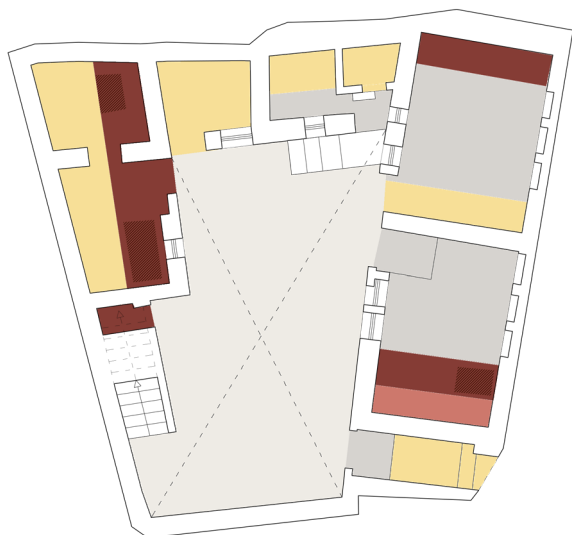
Stato strutturale degli soffitti | Scala 1/200
